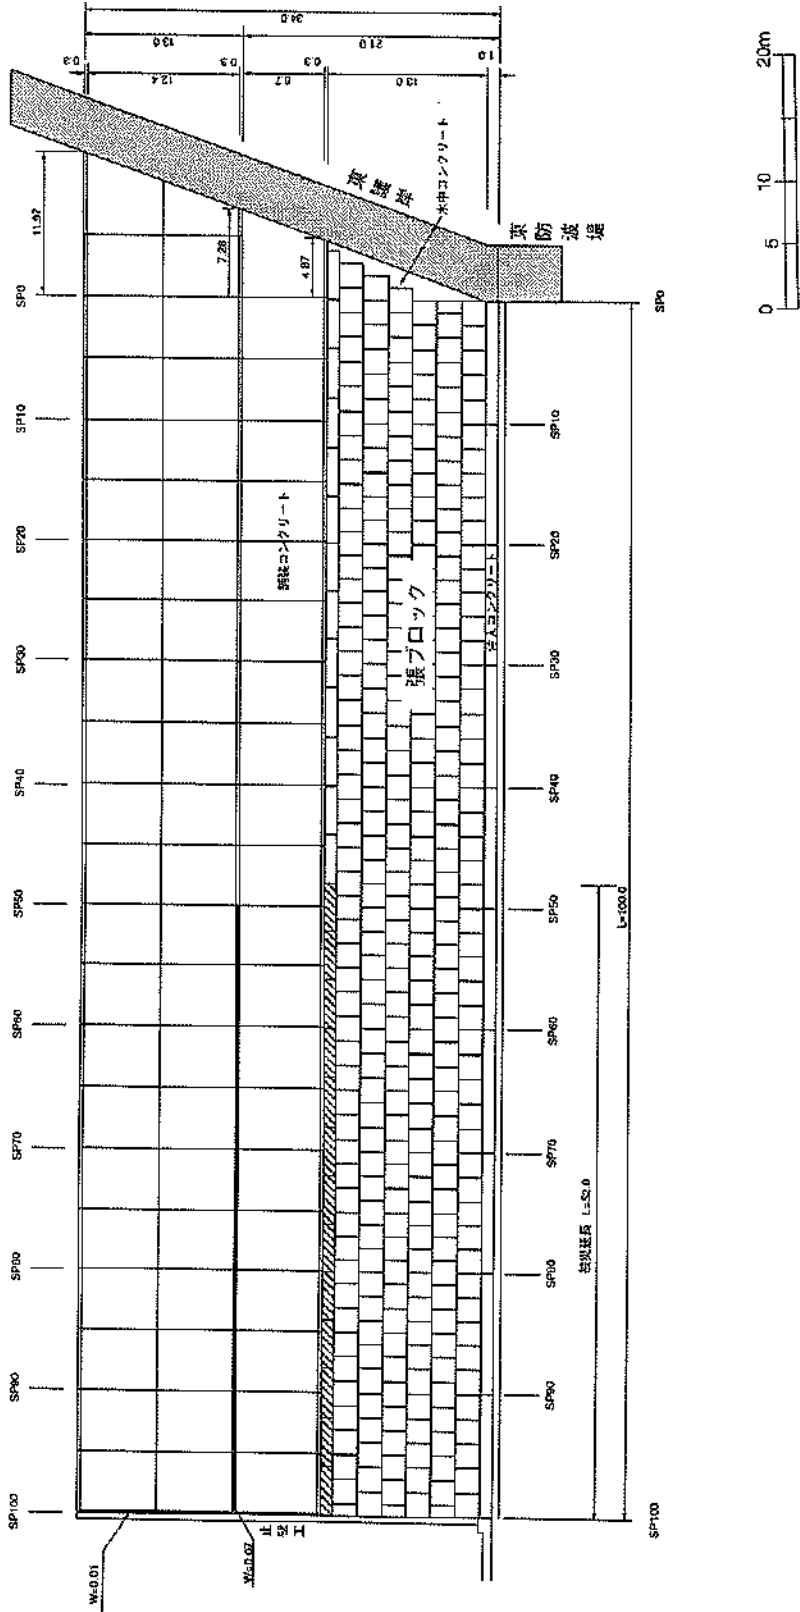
千代ノ浦漁港の④—3.0m岸壁および道路被災状況平面図
